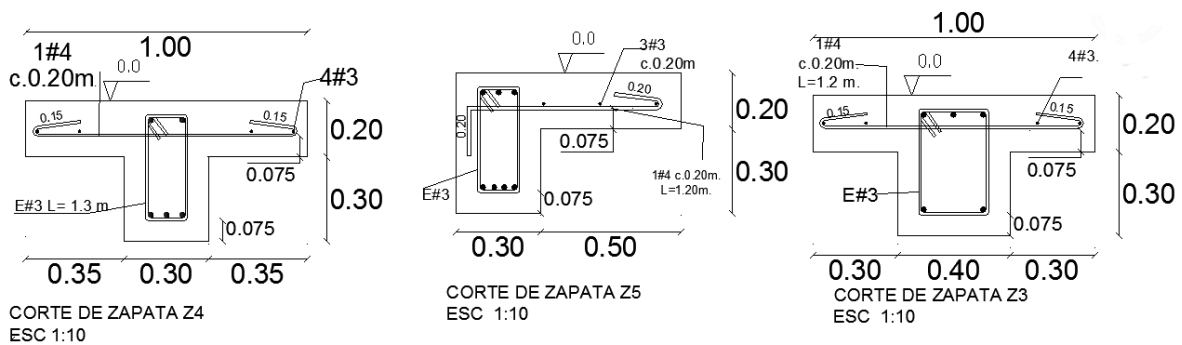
Corte de zapata Z3, Z4, Z5. Fuente: Arquitecto.
